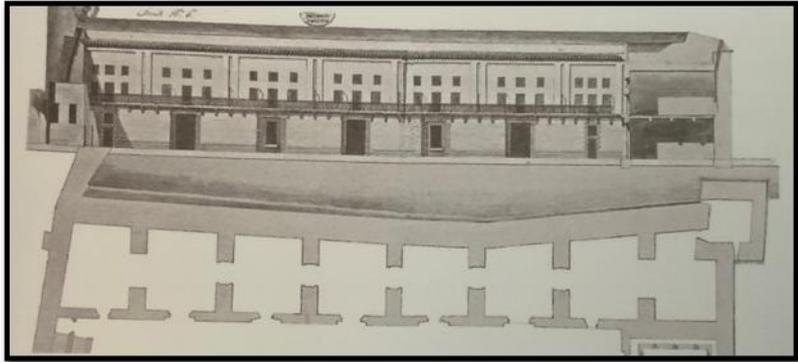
Fachada e planta baixa do projeto do Pavilhão Napoleônico neoclássico
